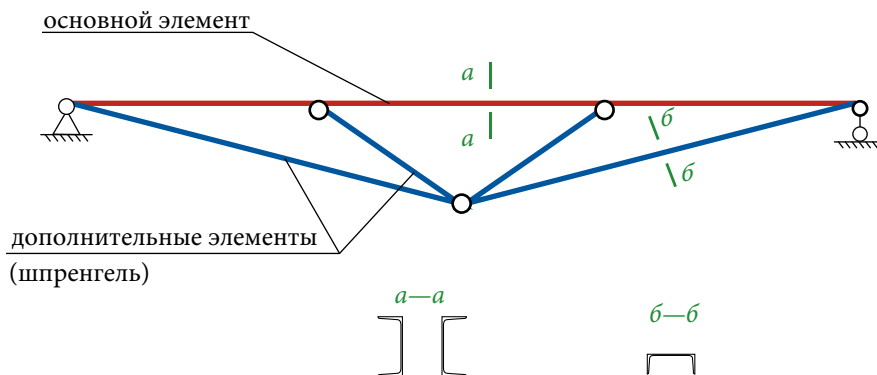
Расчетная схема шпренгельного прогона
